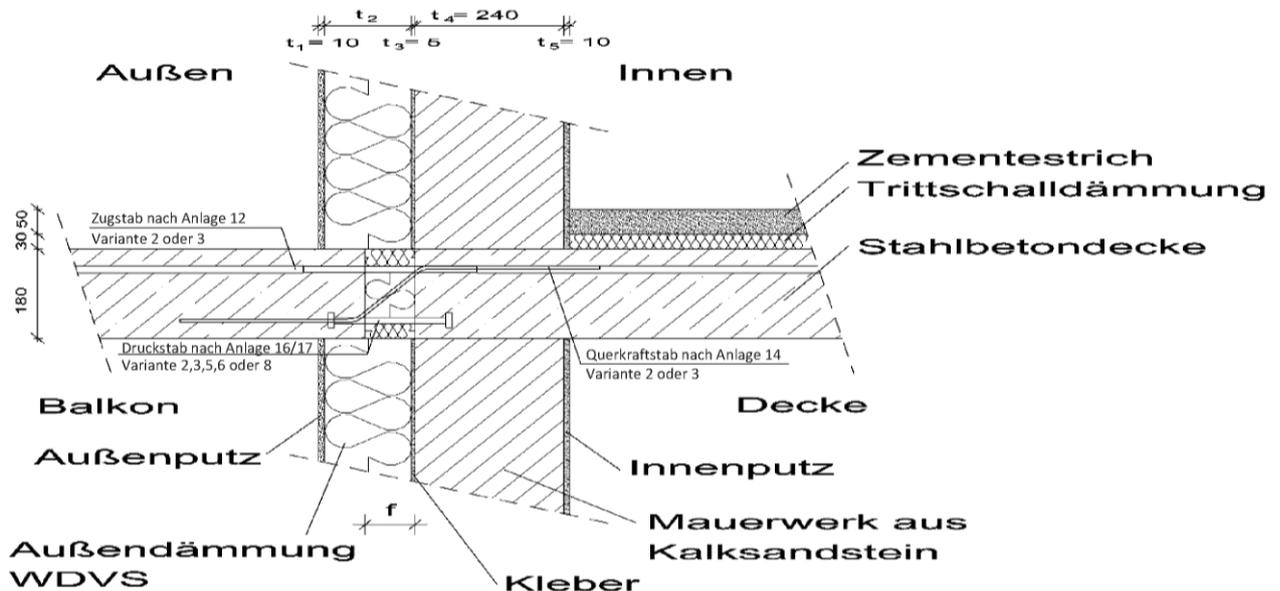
Einbausituation mit Lagerung an gegenüberliegenden Rändern
